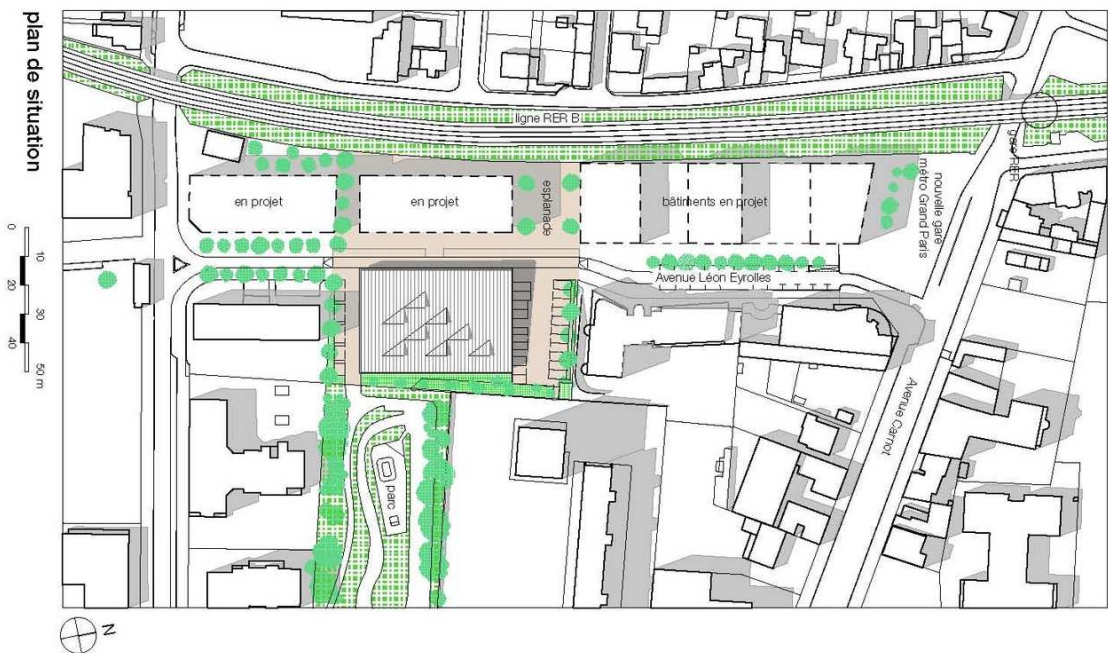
Mercado Cachan P. Fuente: <http://www.archdaily.co>
